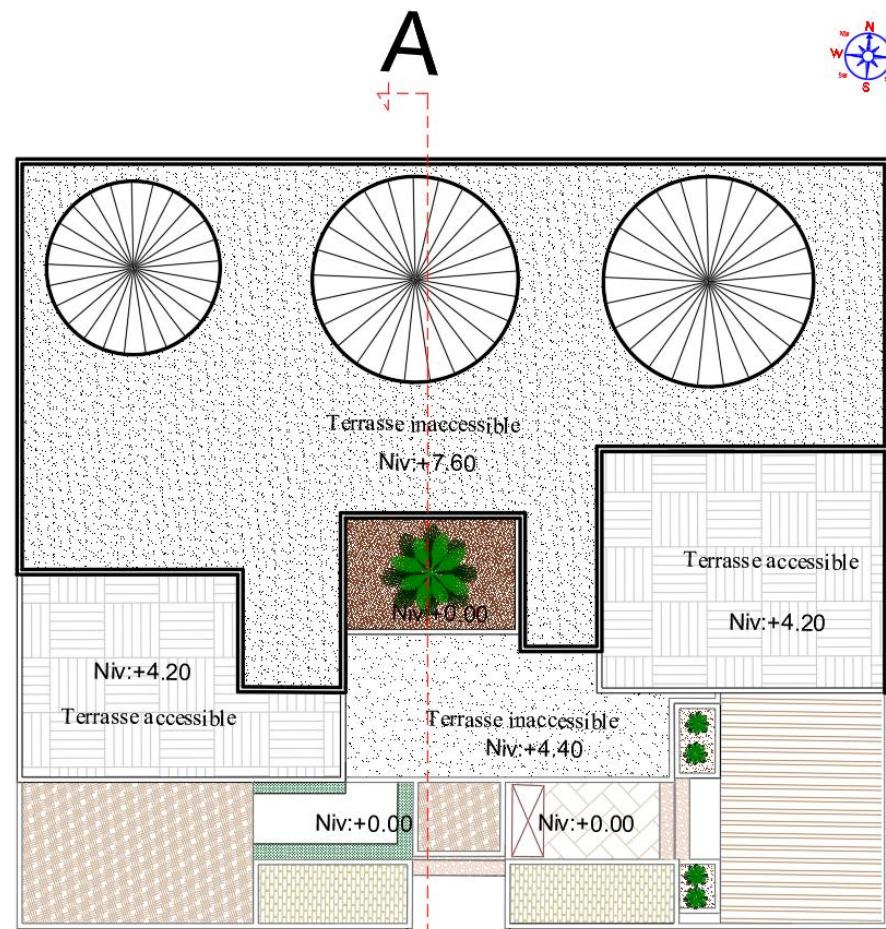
PLAN DE TOITURE LOGEMENT TYPE 1 ; SOURCE:
